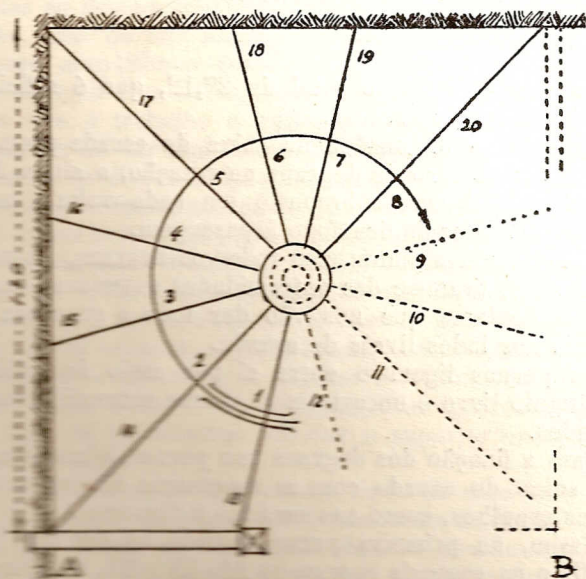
PLANTA INFERIOR DA ESCADA DESMONTÁVEL
